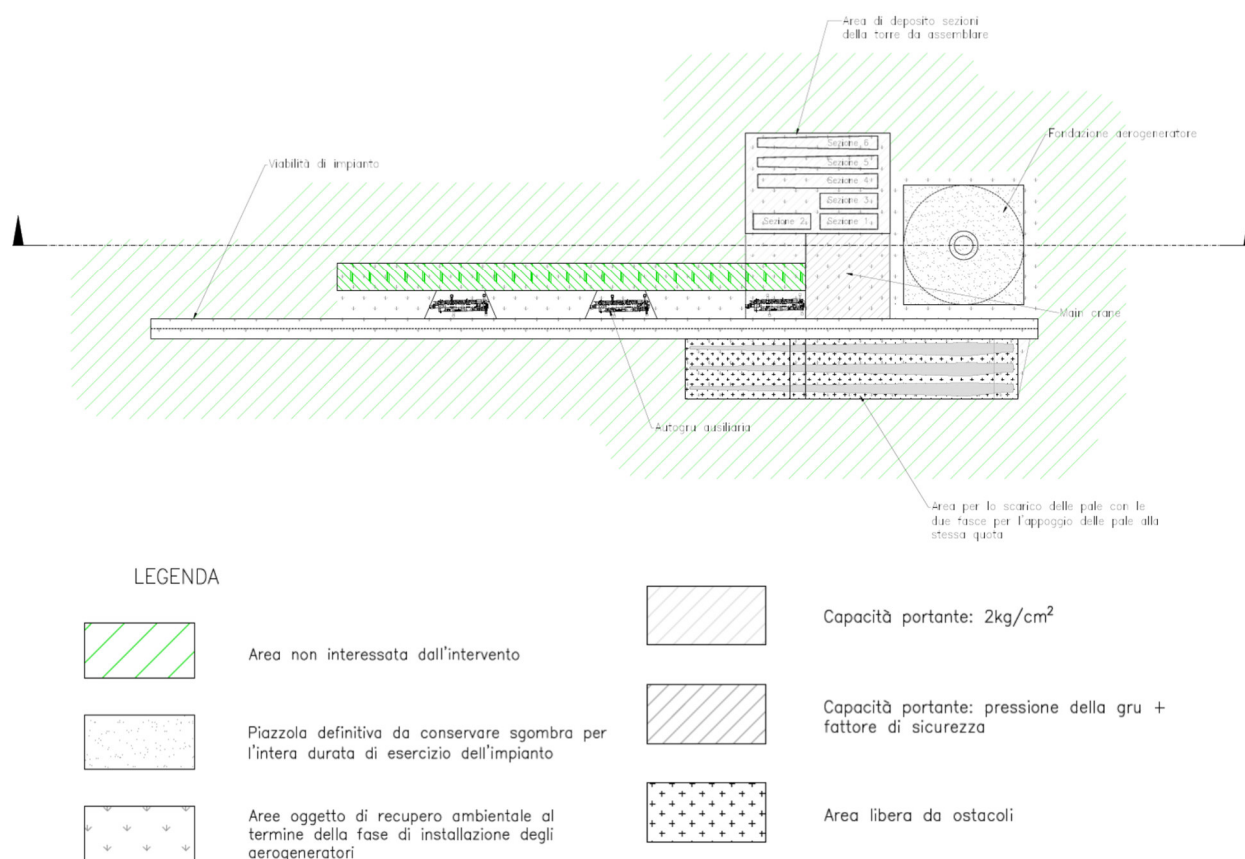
Struttura tipo di una piazzola di cantiere.
